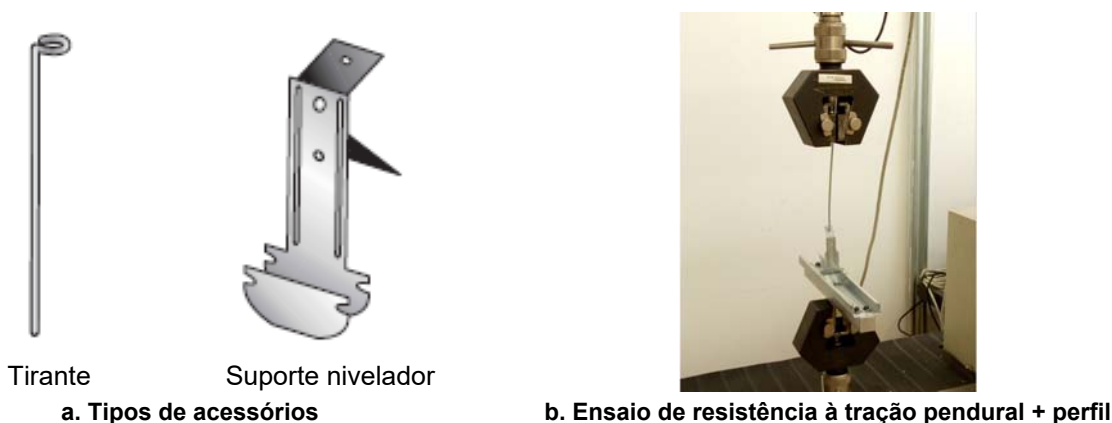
Tipos de acessórios e detalhe do ensaio de tração do pendural + perfil
